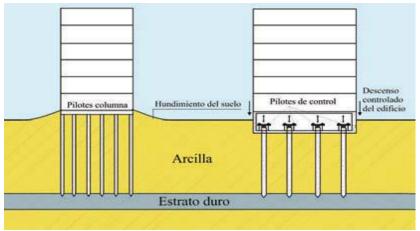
Ejemplo de cimentaciones realizadas con pilotes columna y pilotes de control.
